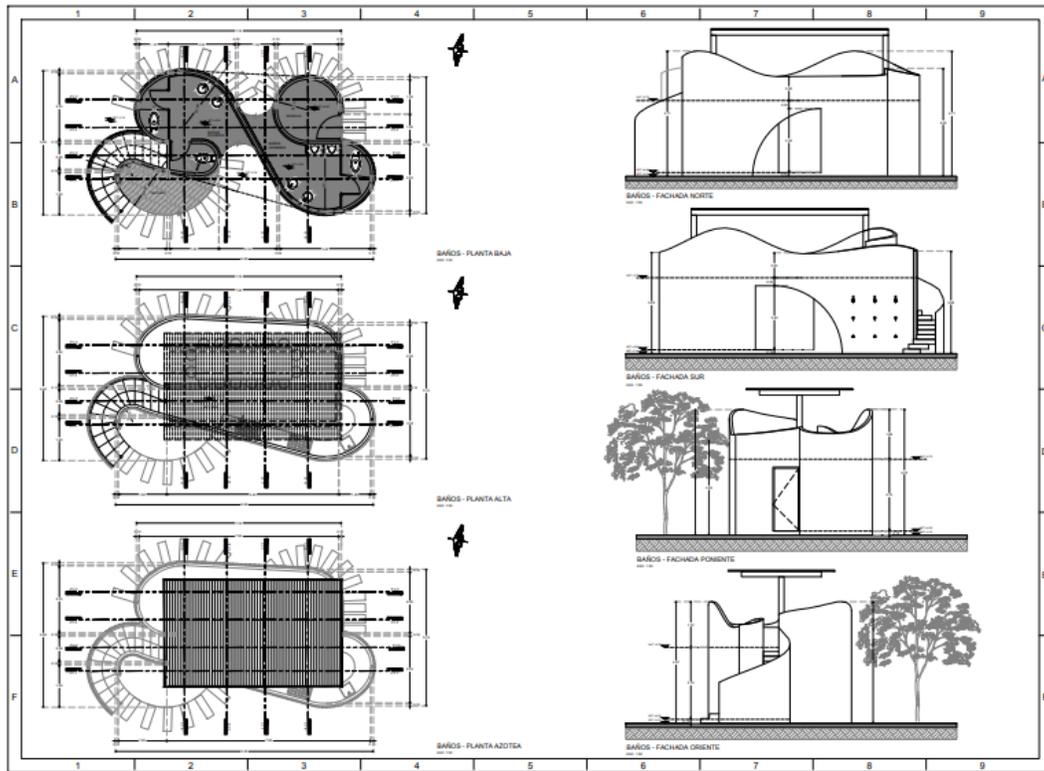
Plano arquitectónico y de cortes del edificio de baños.
